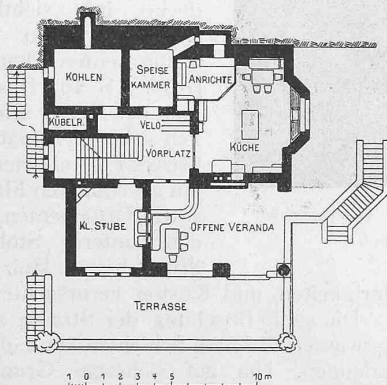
Grundriss vom Untergeschoss. Masstab 1 : 400.
